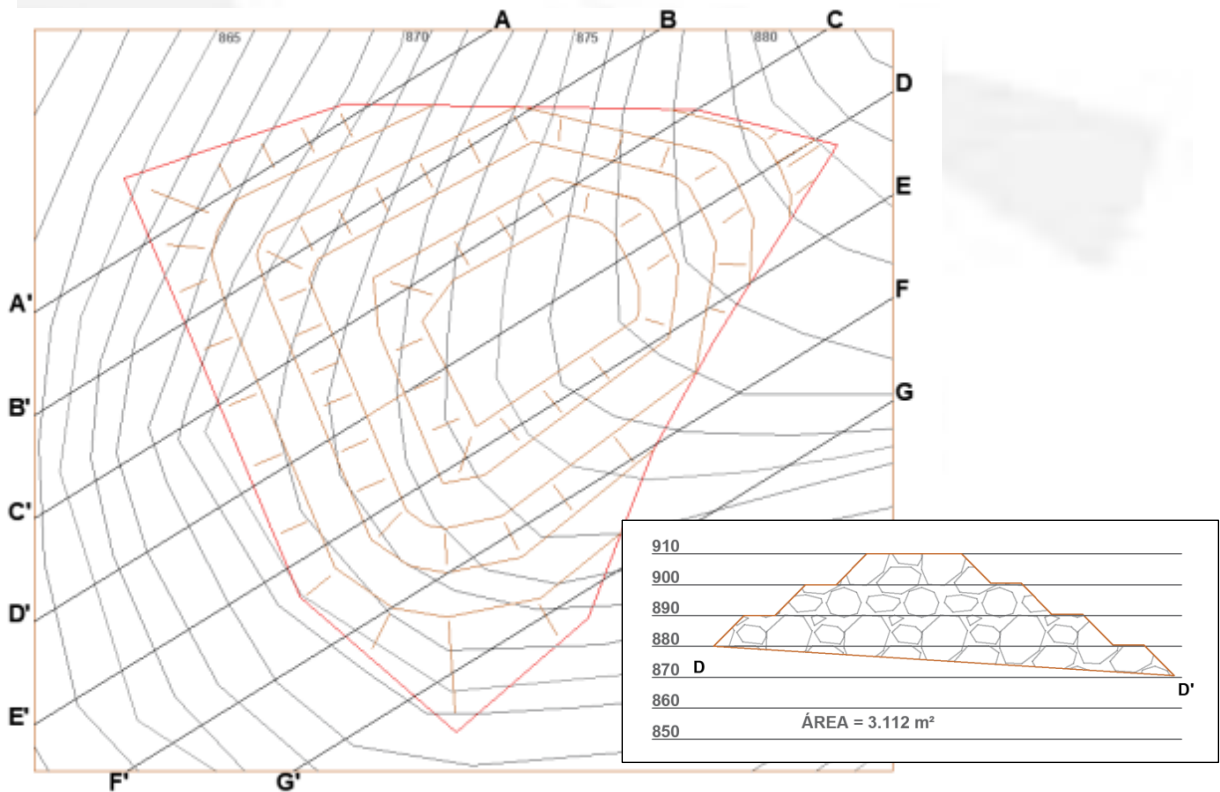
Pilha de estéril com vista superior e perfil topográfico com a projeção da pilha no corte D-D'. Fonte: RAS
